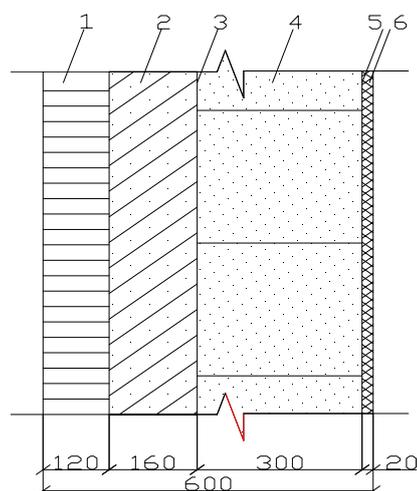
Ограждающая конструкция с использованием монолитного железобетона:
